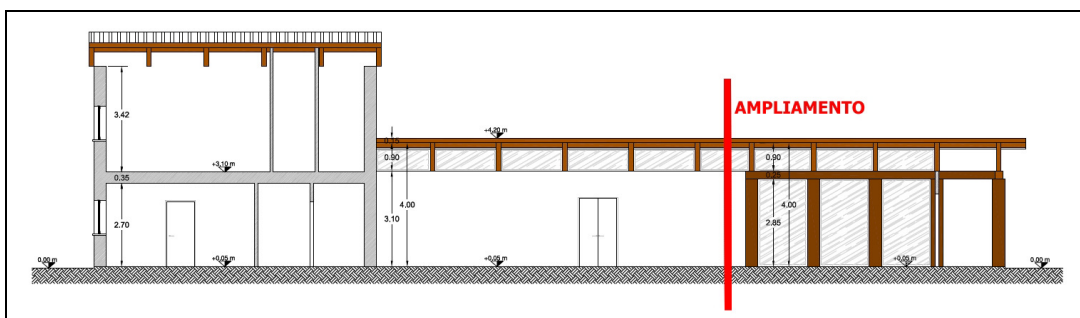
Progetto: sezione B-B (tratta dalla Tavola n. 5)
